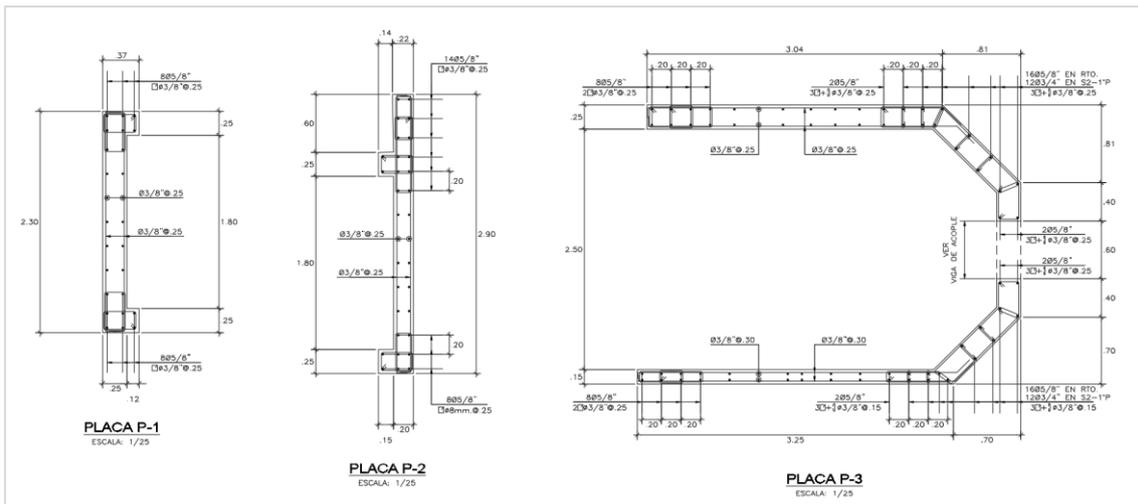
Detalle de las placas P-1, P-2 y P-3
